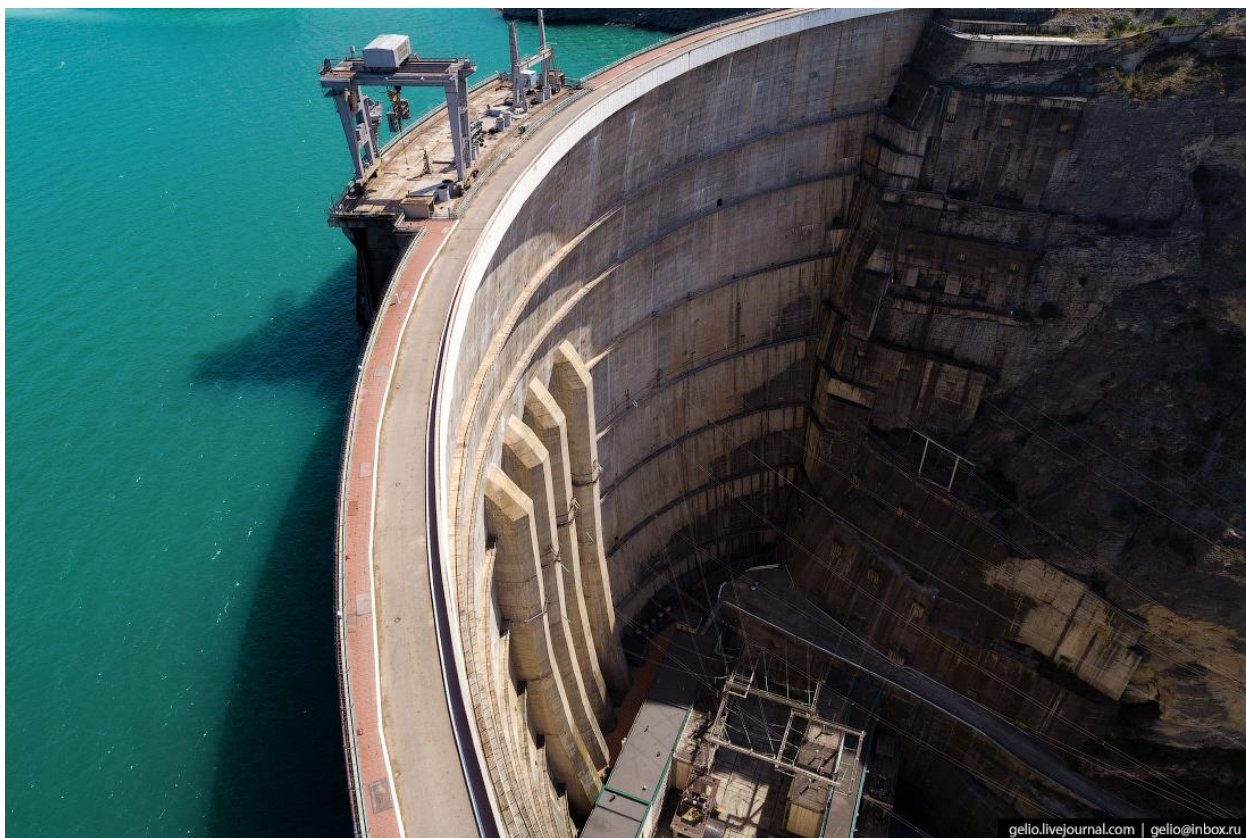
Внешний вид арочной плотины Чиркейской ГЭС
